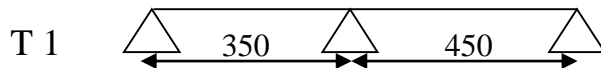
6 : Schémas de disposition des poutrelles du plancher 16+5
